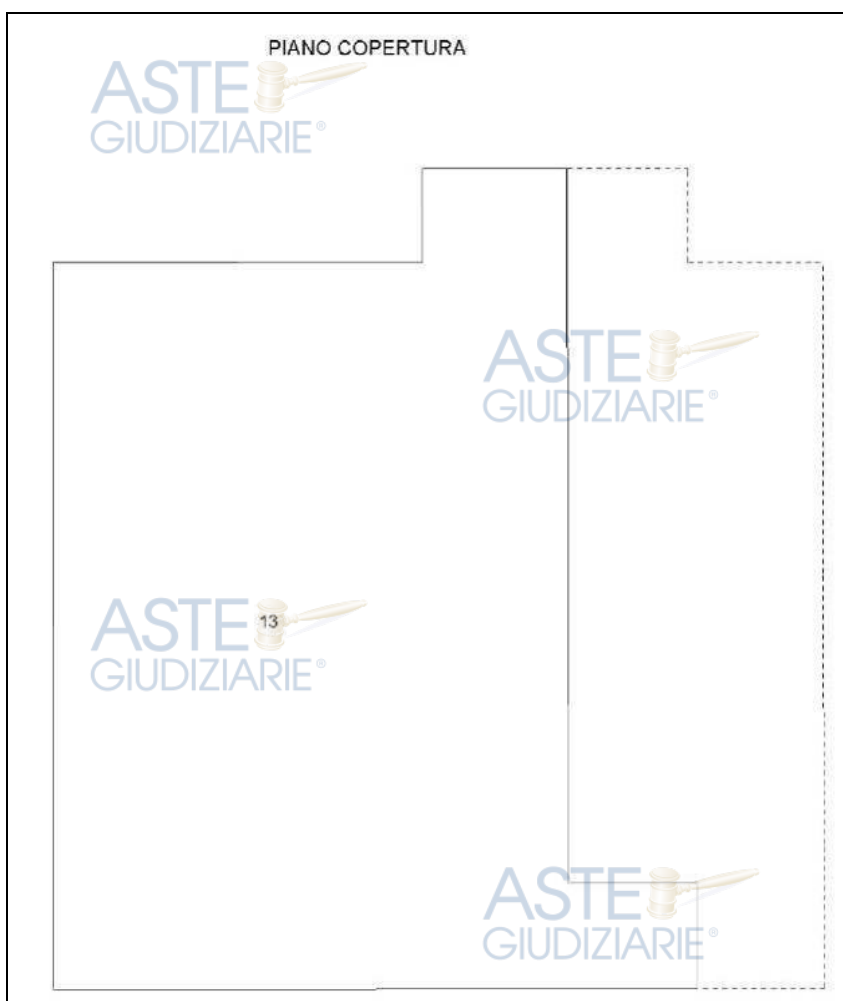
Estratto elaborato planimetrico catastale – PIANO COPERTURA
